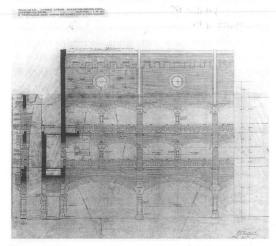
Plano de construcción de La Bolsa de Amsterdam, 1898. Dibujo de Berlage.
